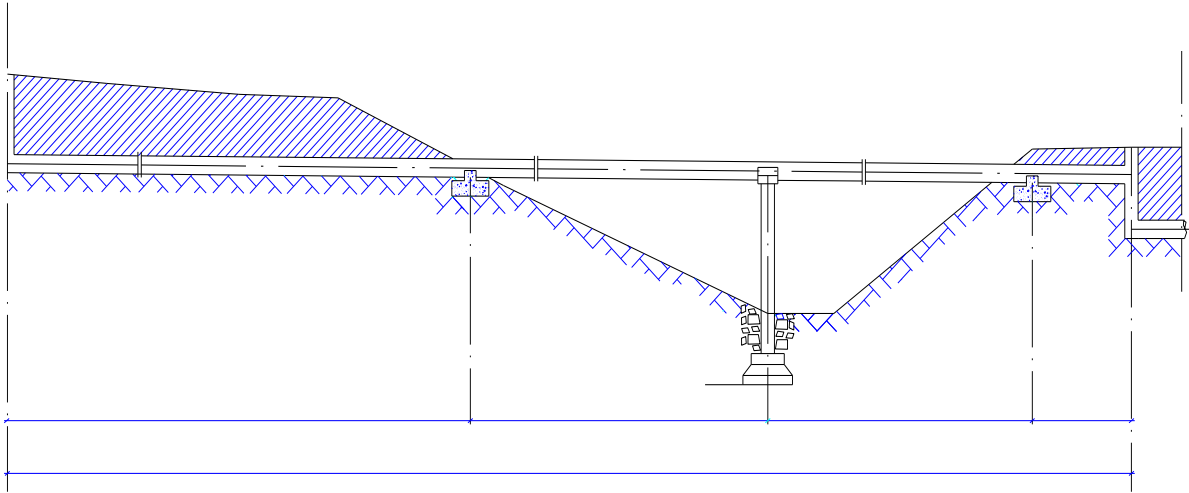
la traversée d'une rivière ou oued avec un pont-route
